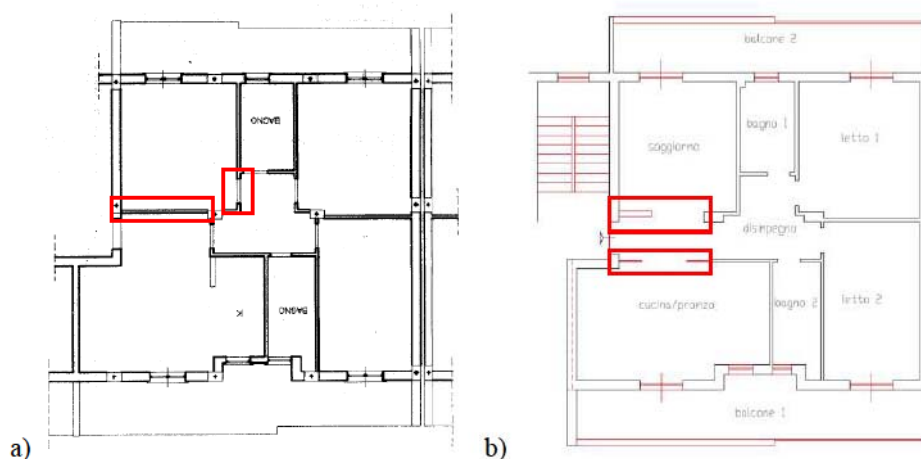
Appartamento: a) Planimetria del titolo autorizzativo; b) Planimetria stato di fatto
